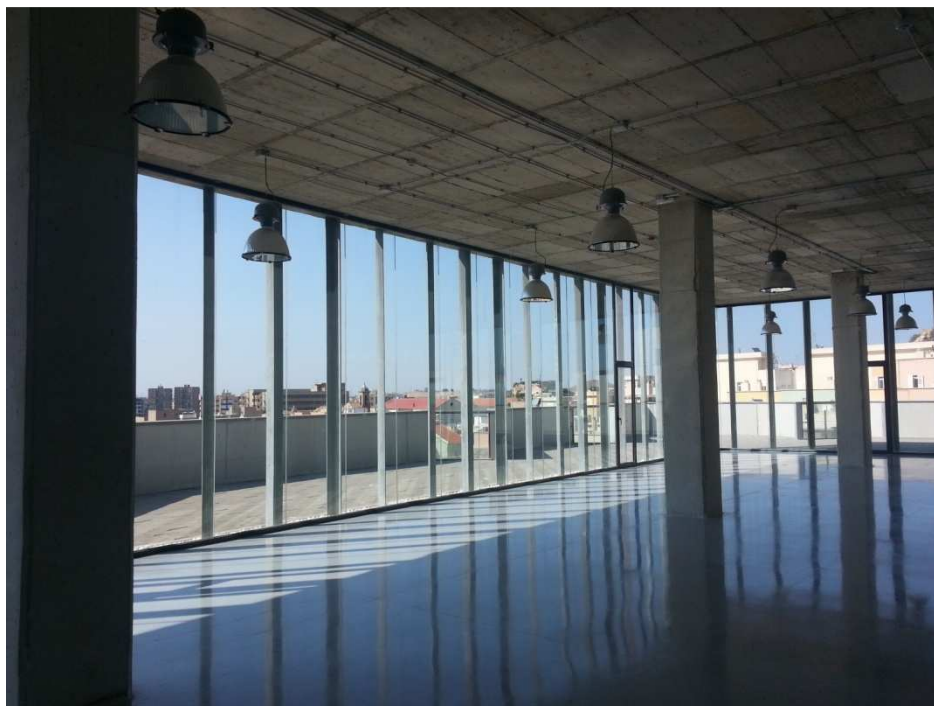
Cristalera instalada como cerramiento exterior de fachadas
